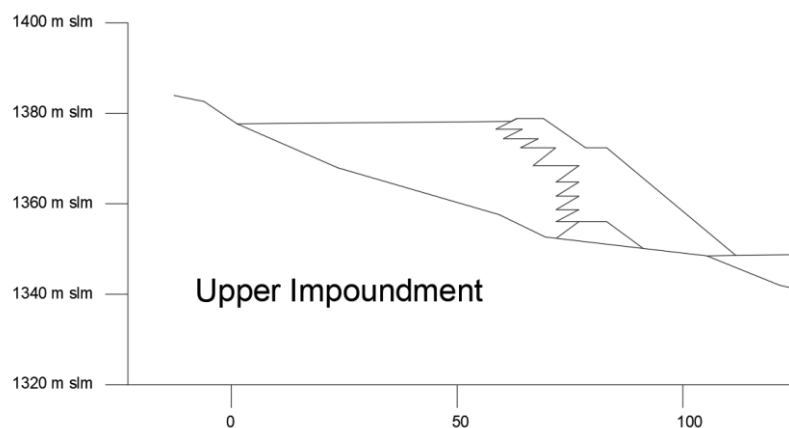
Sezione tipo ricostruita del bacino superiore delle tailings dam di Stava
